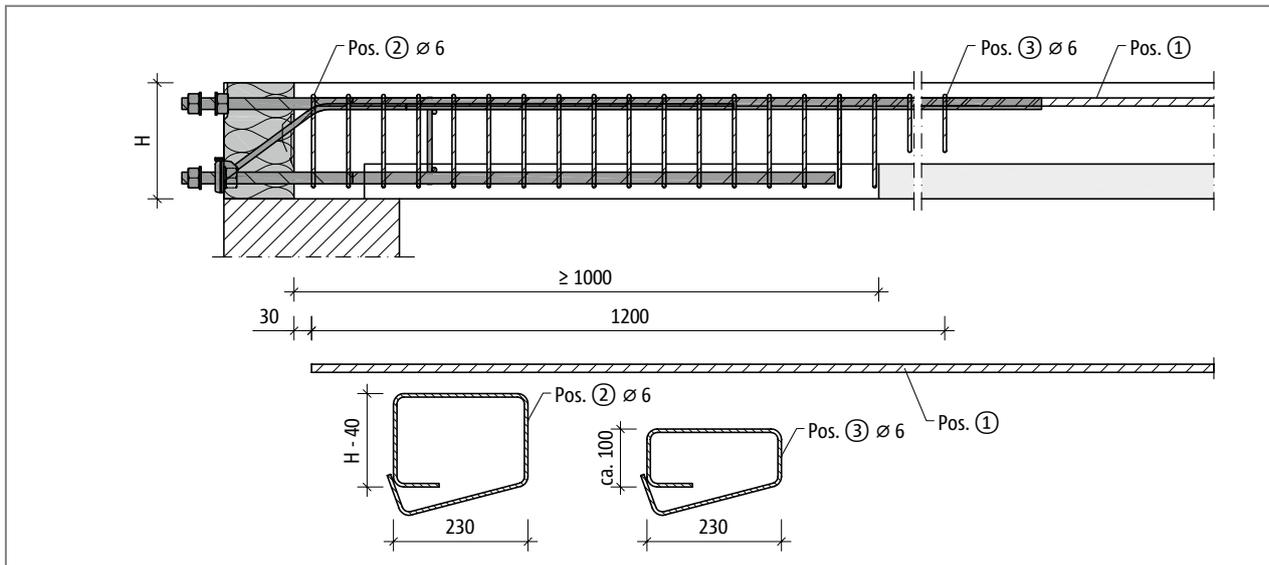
Schöck Isokorb® XT Typ SK-MM2: Bauseitige Bewehrung bei Fertigteilbauweise mit Bügel  $\varnothing 6$  mm; Schnitt
